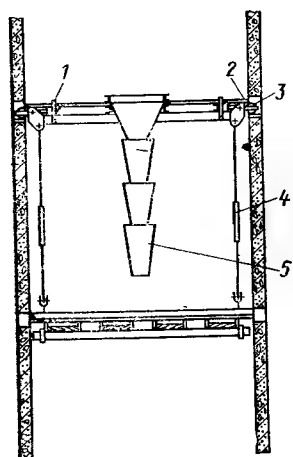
Воронка для подачи бетонной смеси в опалубку перекрытий:
